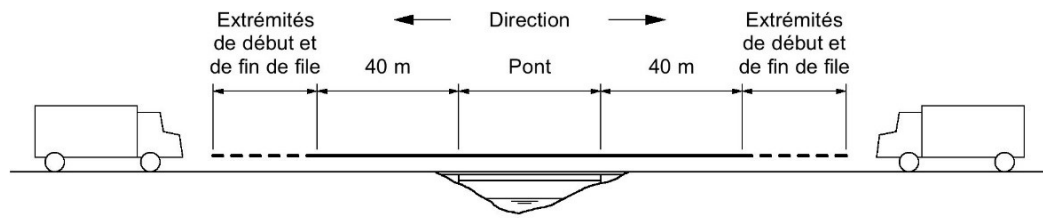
Longueur minimale des barrières de sécurité sur les autres routes
